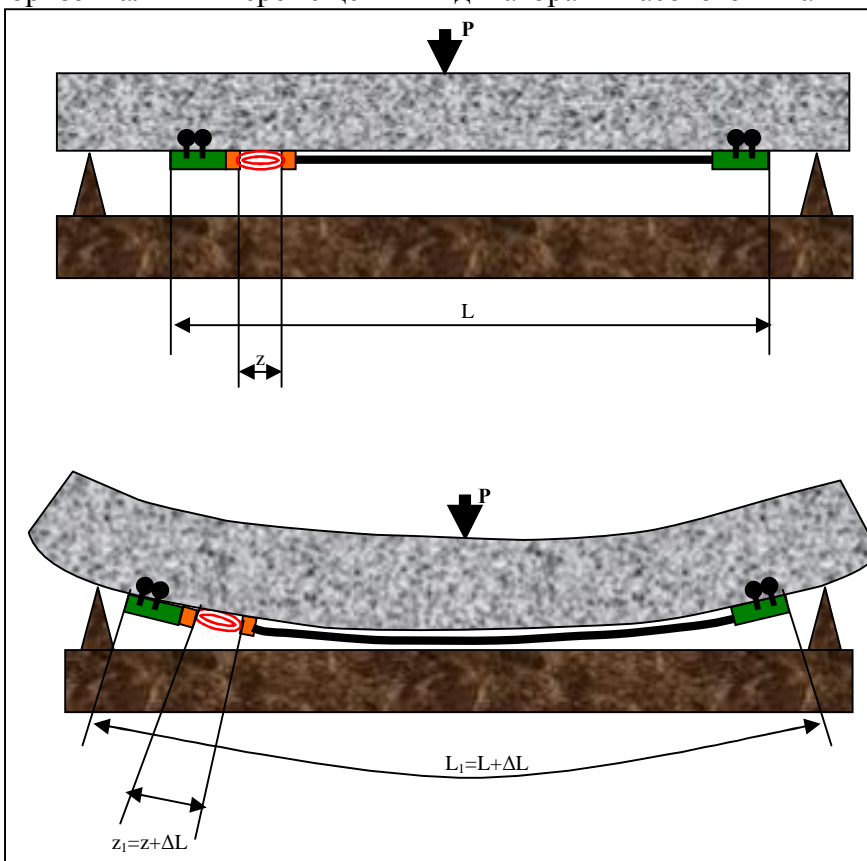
Схема измерения удлинения железобетонных перемычек с помощью ВОДД-2
